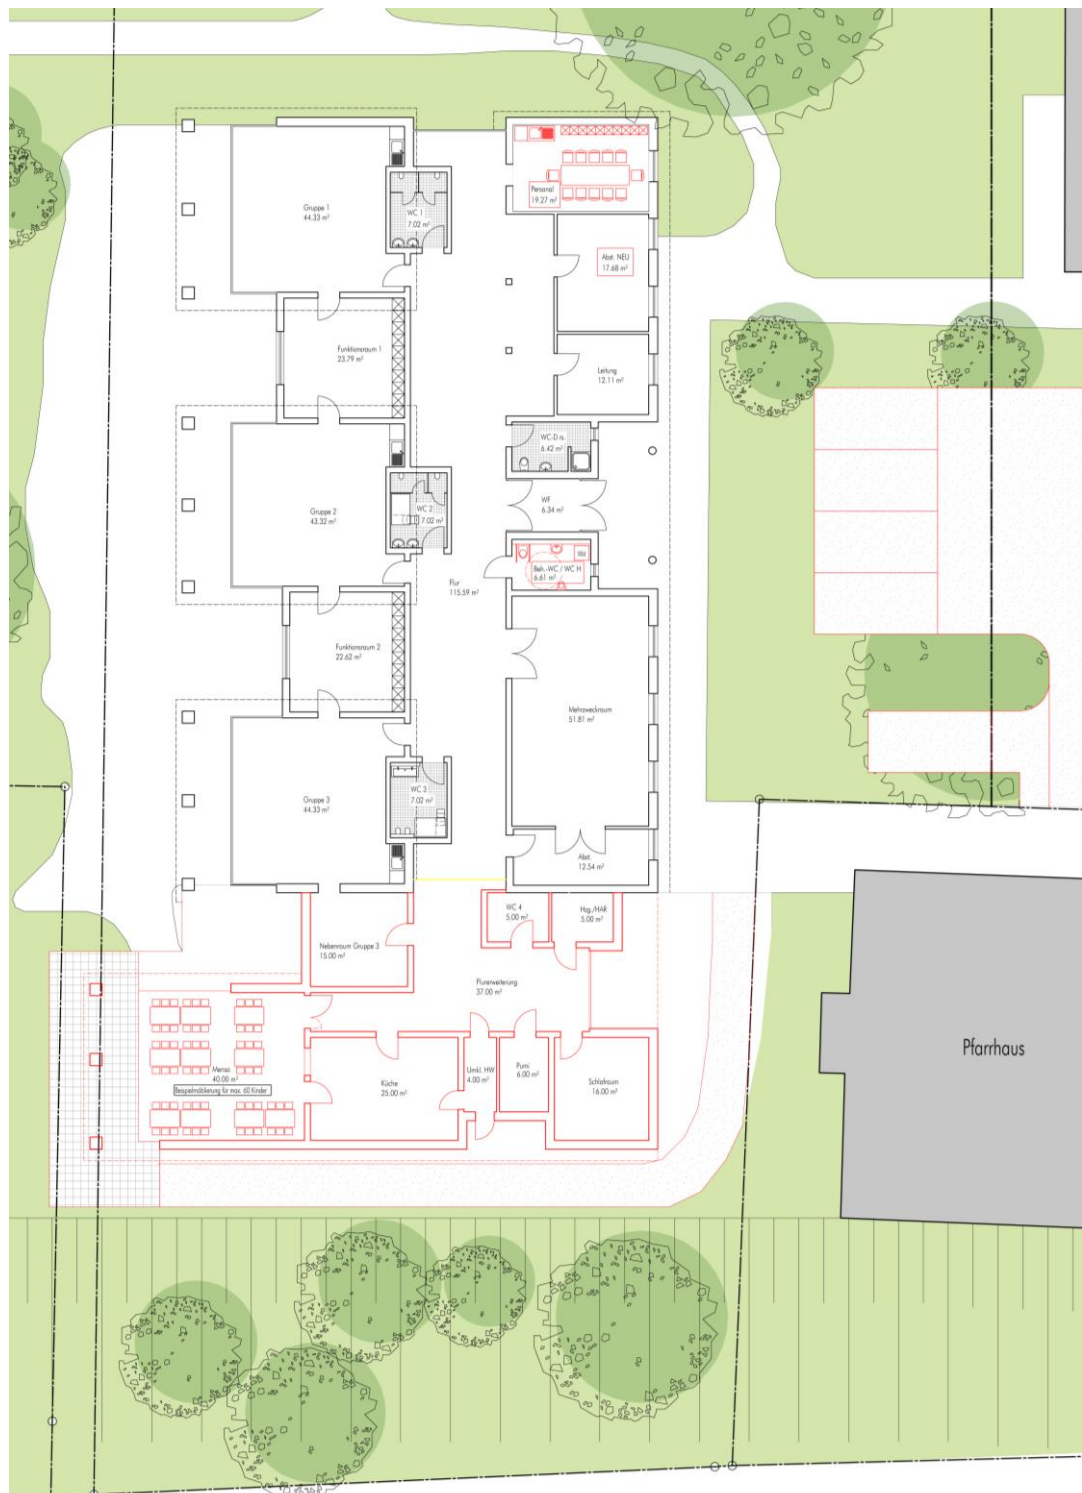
Grundriss Machbarkeitsstudie
